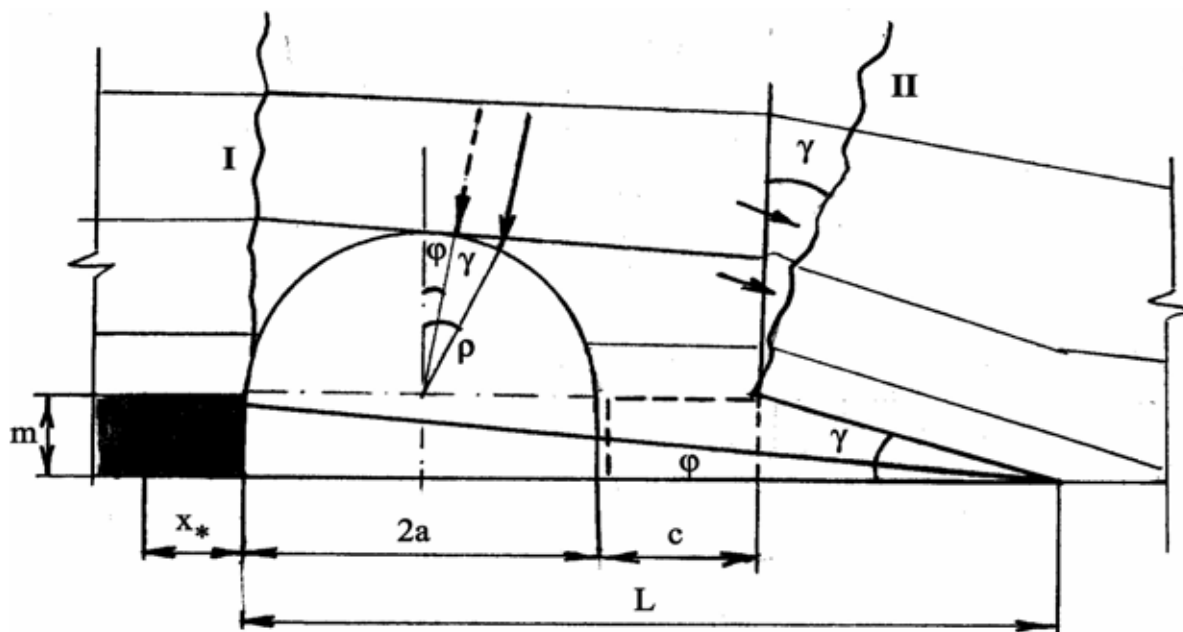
Схема формирования нагрузки на арочную крепь подготовительной выработки
